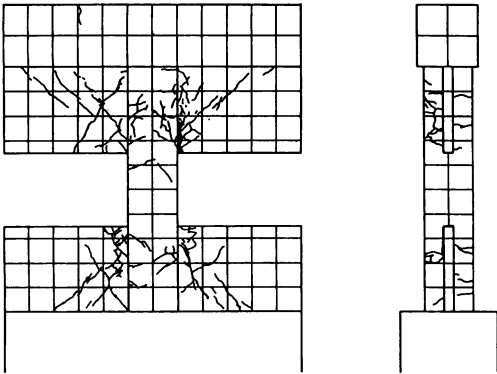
(e) 試験体 CSS05 最大耐力時のひび割れ図
